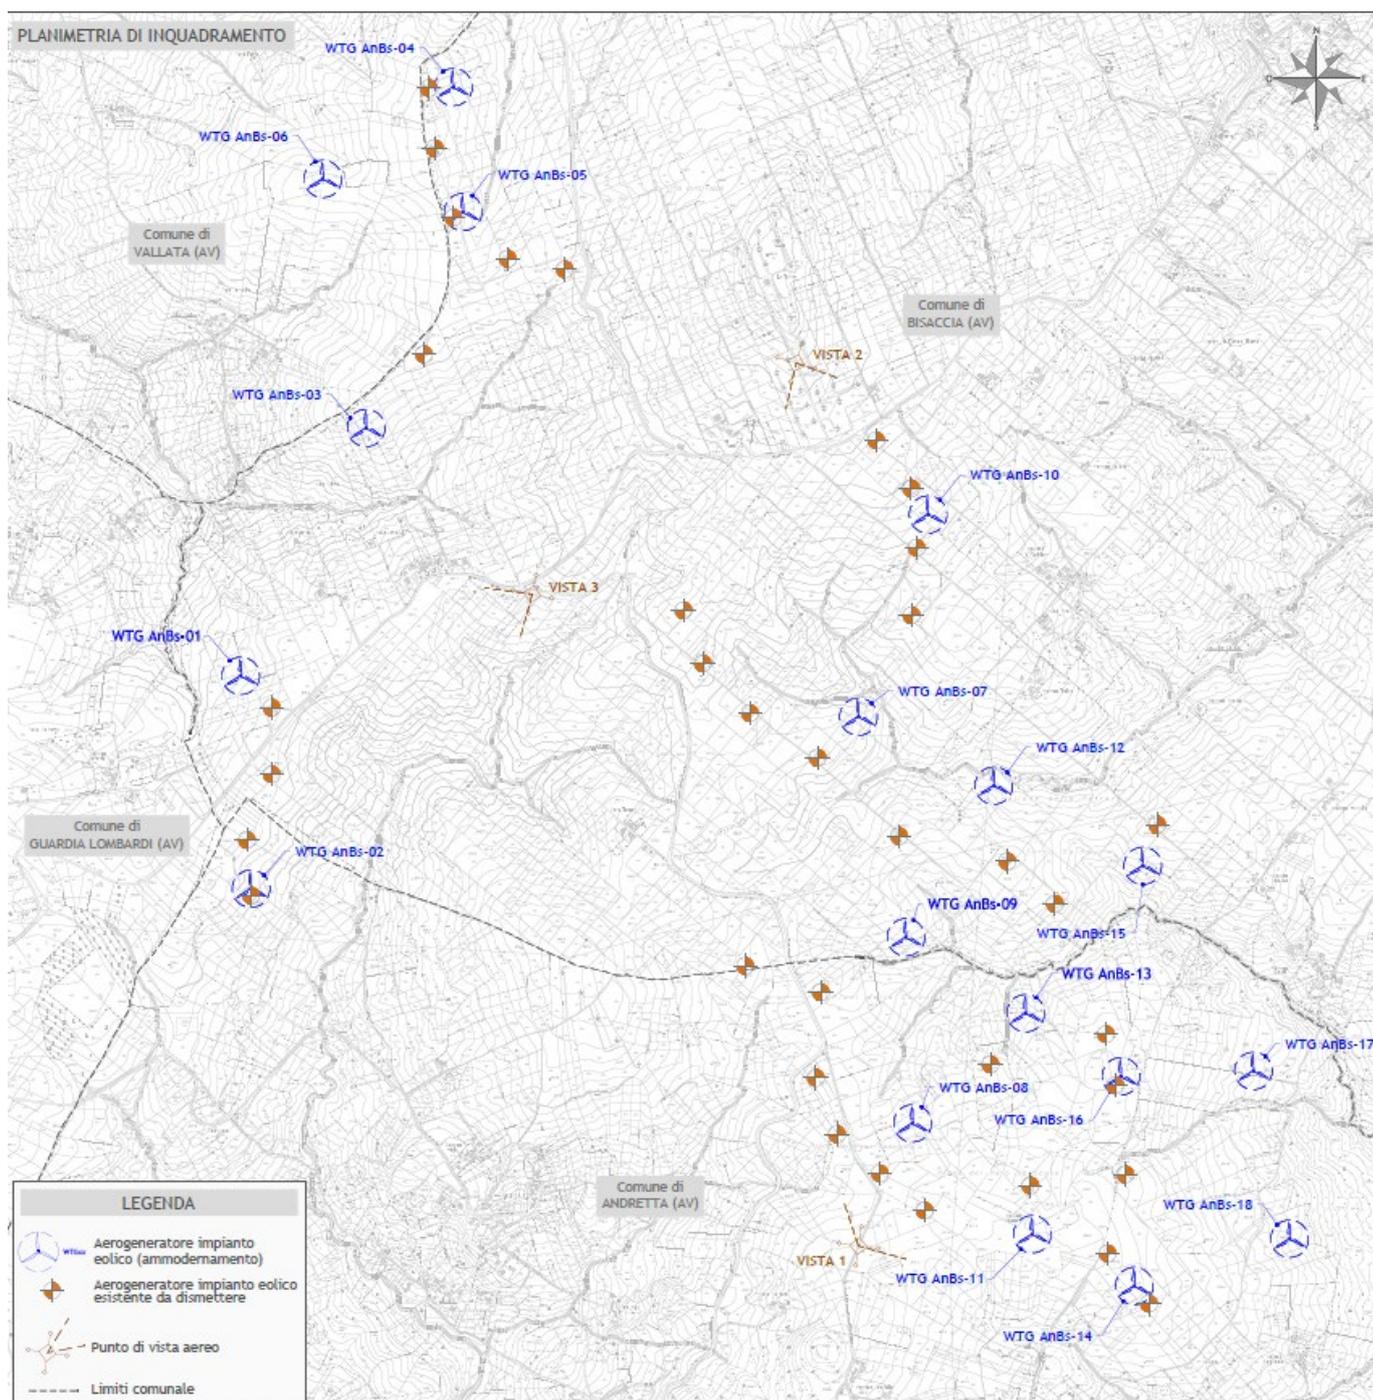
Stralcio della planimetria CTR con ubicazione punti di vista aerei per la documentazione fotografica attestante le condizioni del sito prima dell'intervento d'ammodernamento
